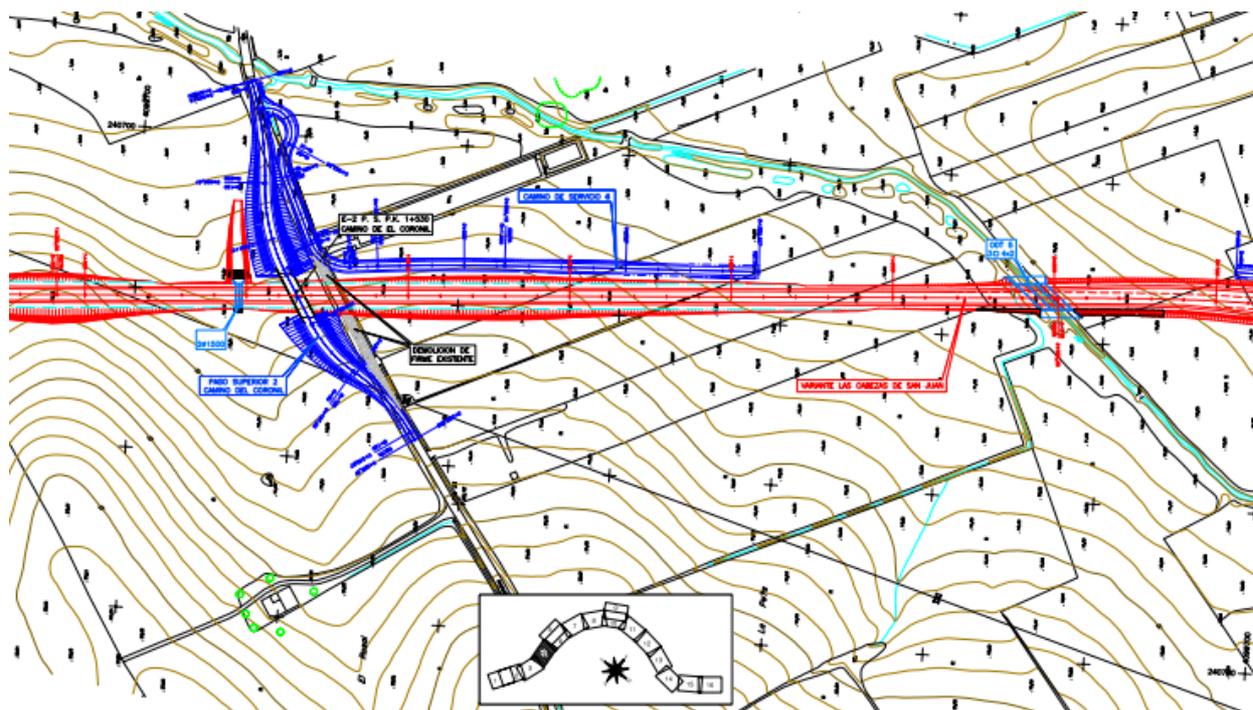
Vista en Planta. Variante de las Cabezas
